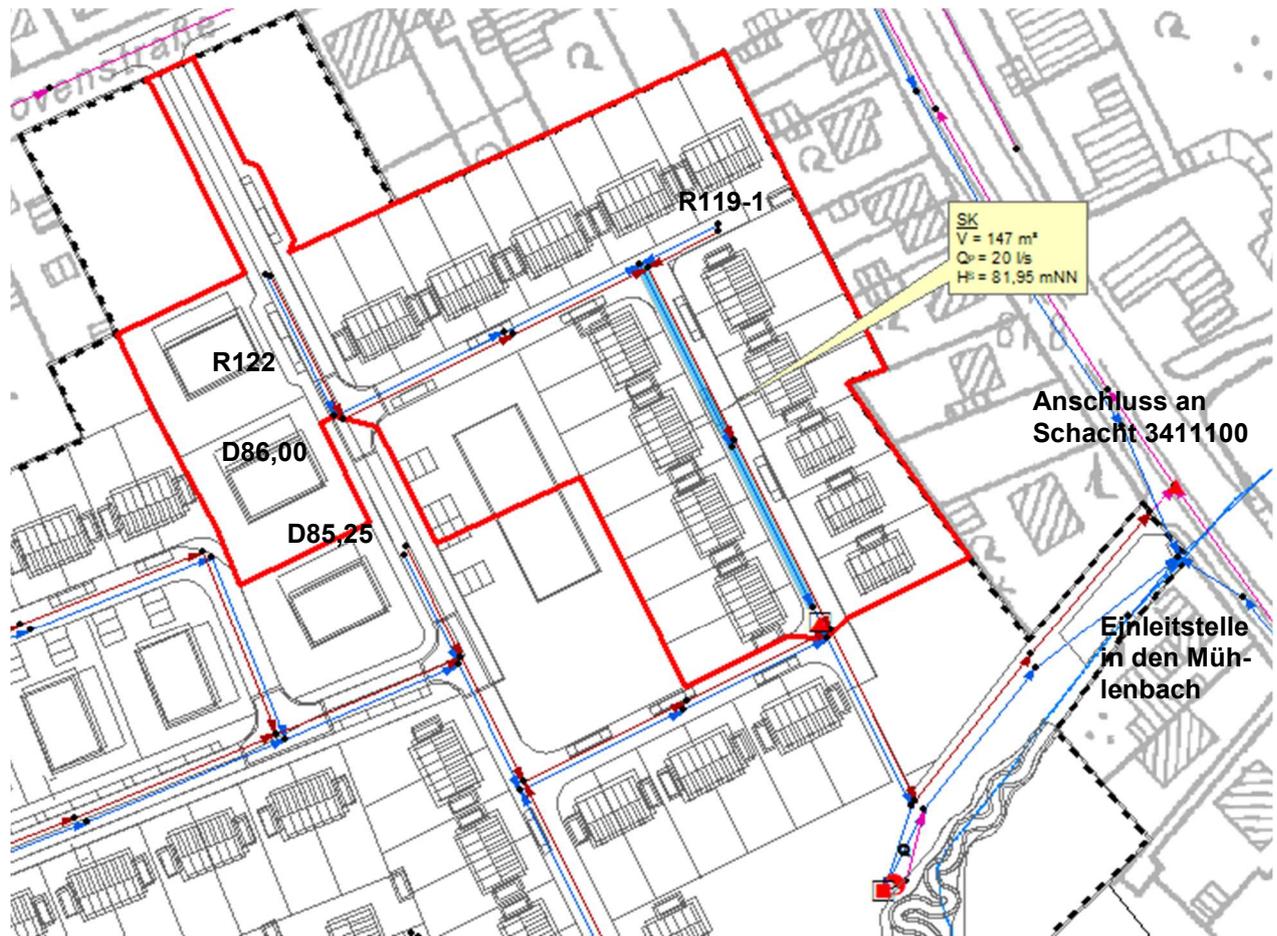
Variante 2: Regenwasser-Stauraumkanal
